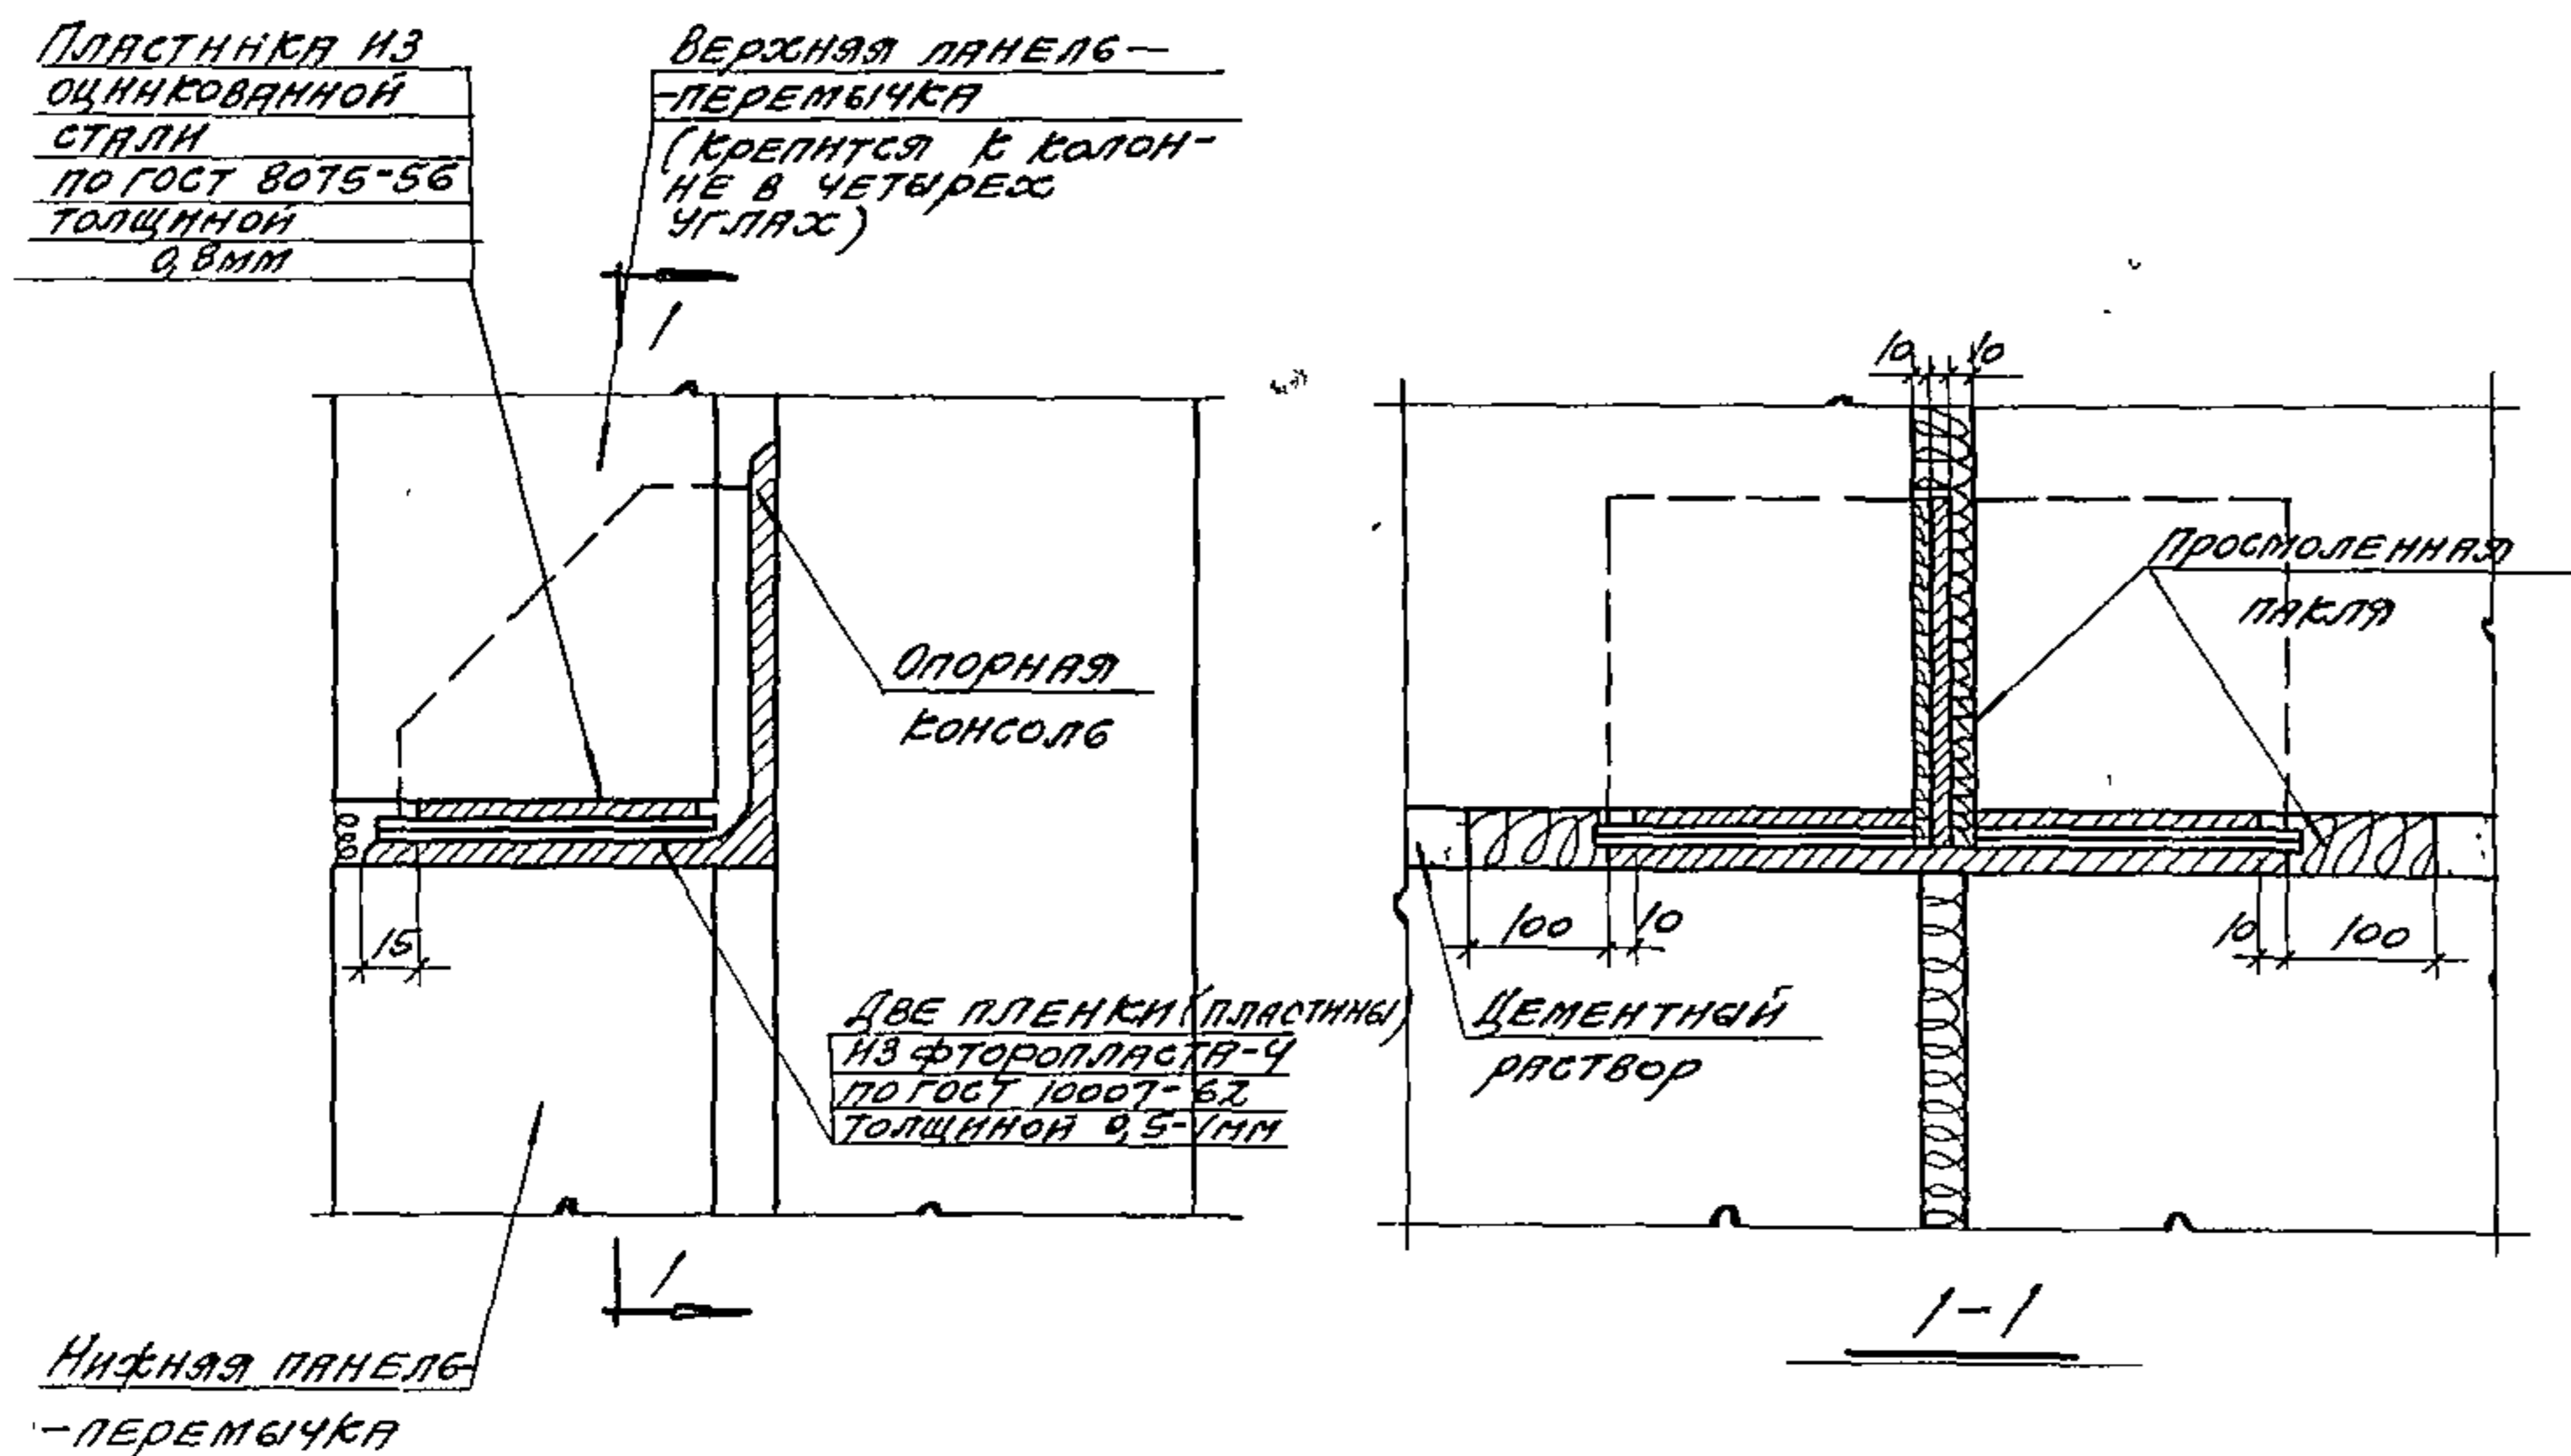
Температурный шов в продольных навесных панельных стенах на одной колонне (крепление панелей к колоннам условно не показано).
